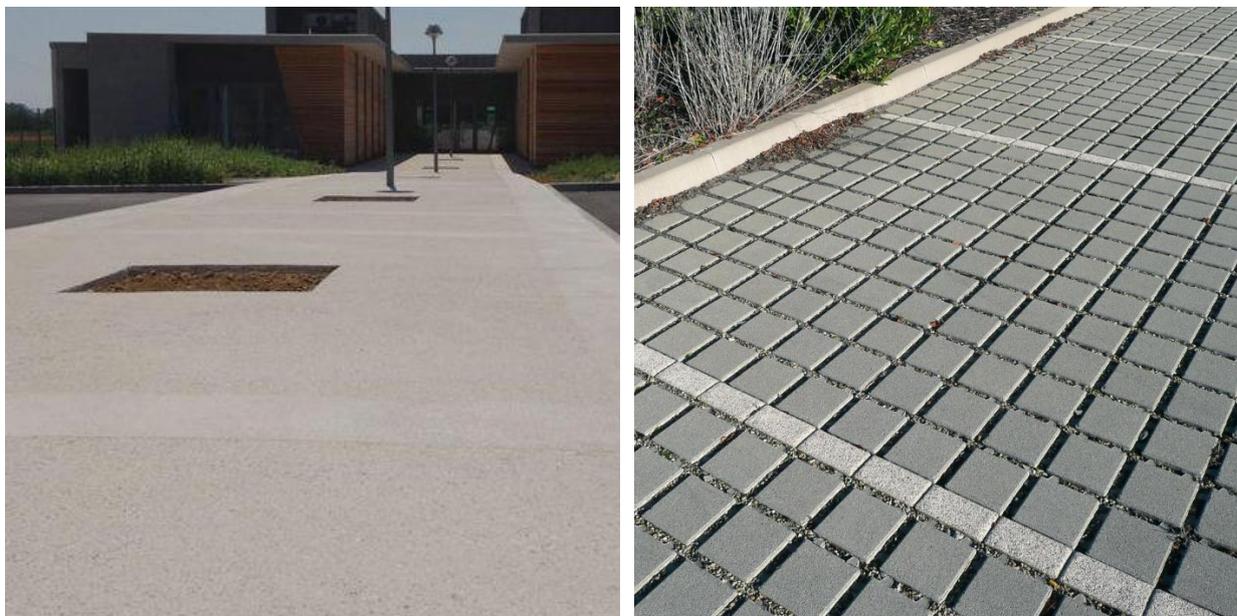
Exemple de revêtement en béton sablé (à gauche) et de pavé à gros jointoiment (à droite)
